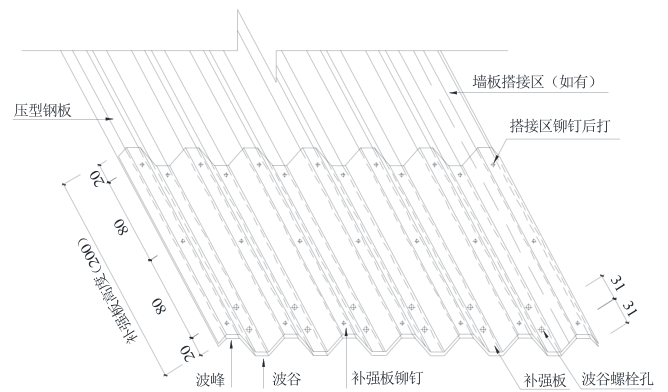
补强板连接构造与铆钉布置示意 (单位: mm)
